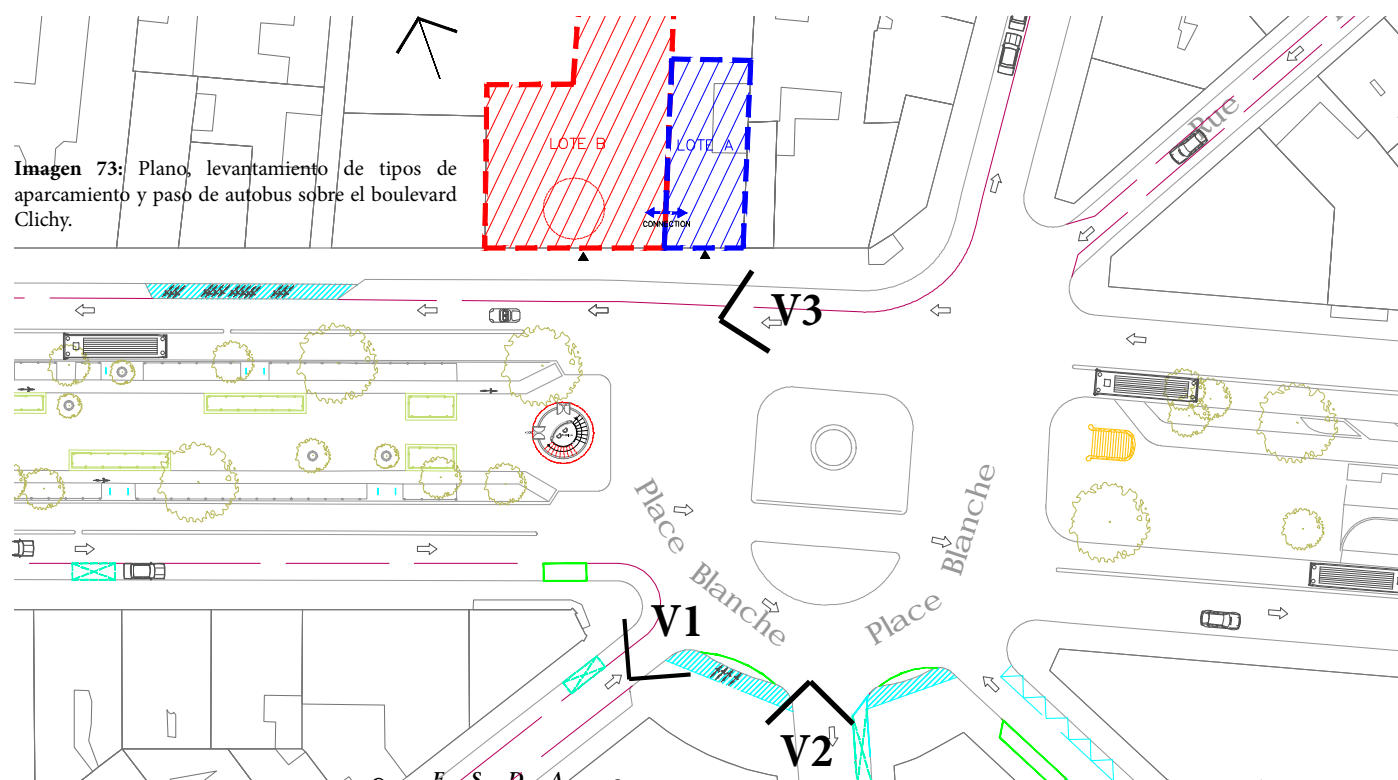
Plano, levantamiento de tipos de aparcamiento y paso de autobus sobre el boulevard Clichy.
